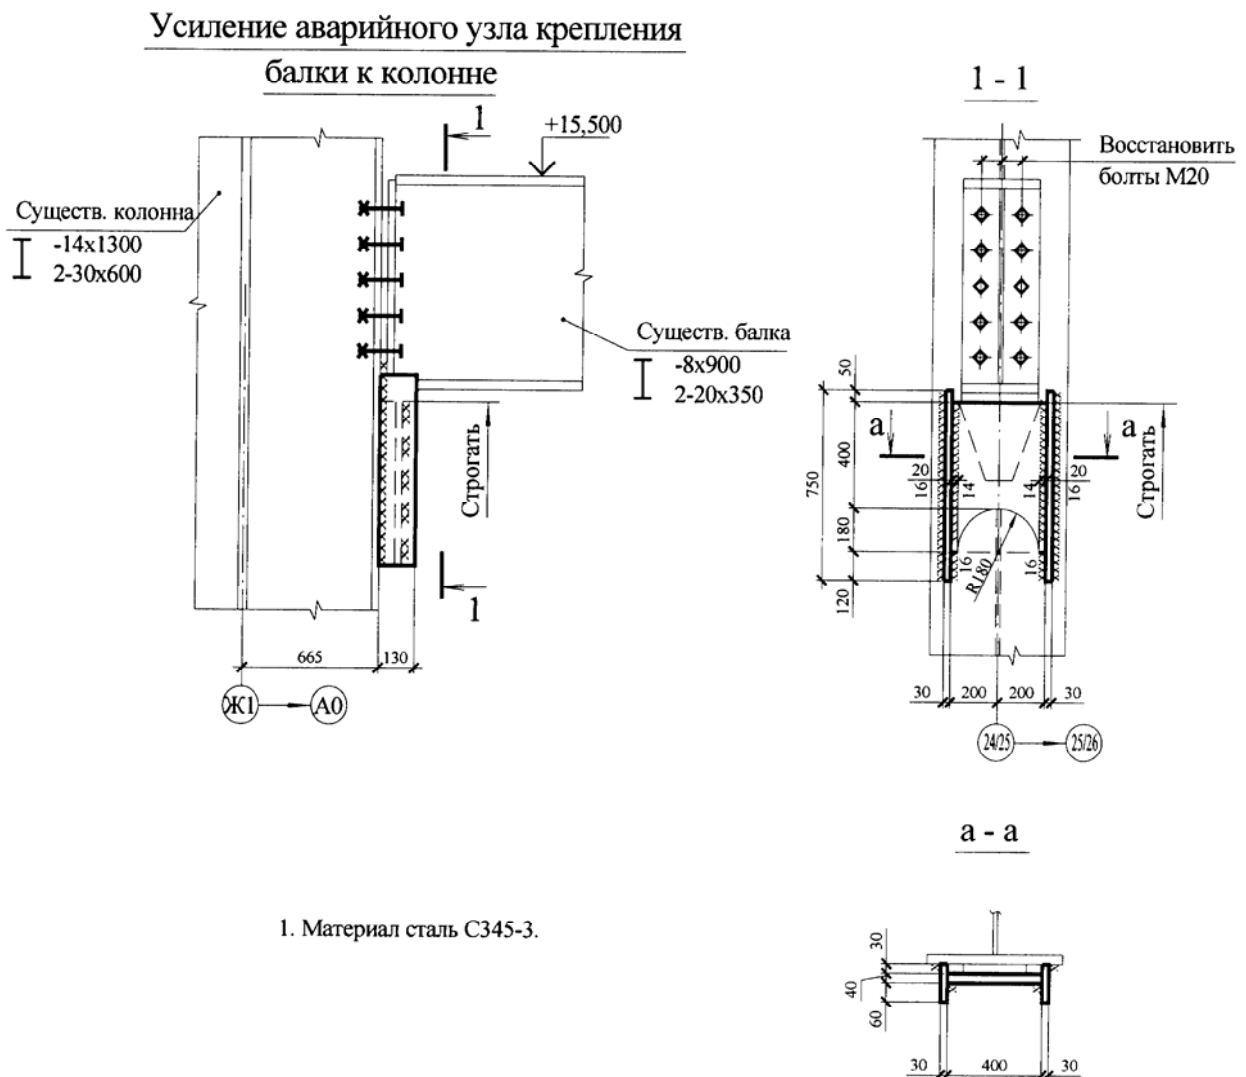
Усиление аварийного узла крепления балки к колонне.
